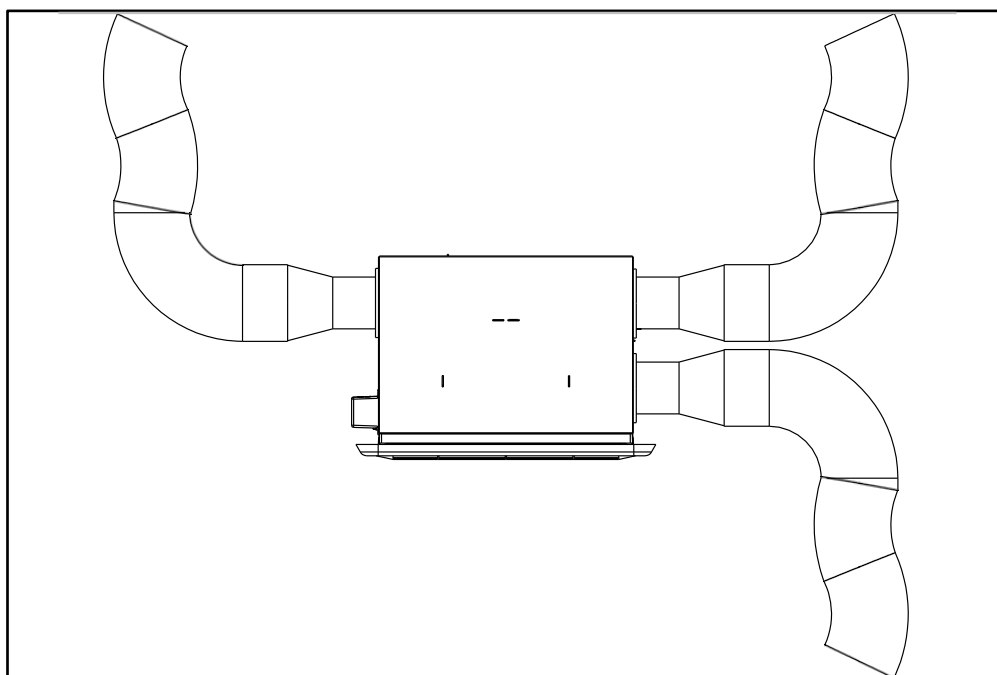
INSTALLATION DES CONDUITS FLEXIBLES
